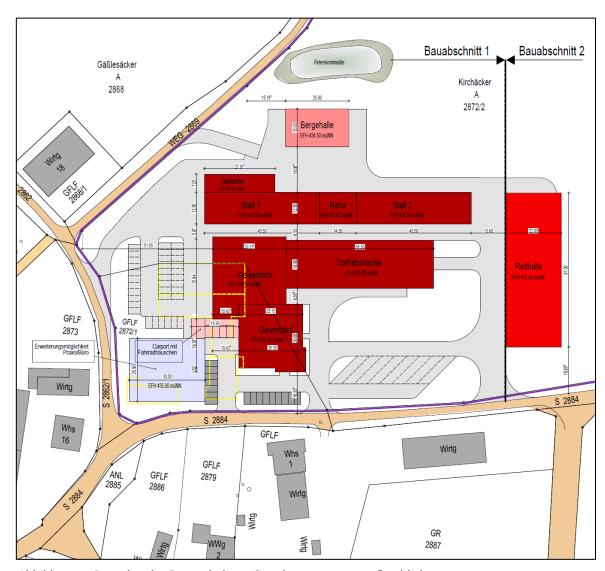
Lageplan des Bauvorhabens, Stand 24.01.2024, unmaßstäblich
